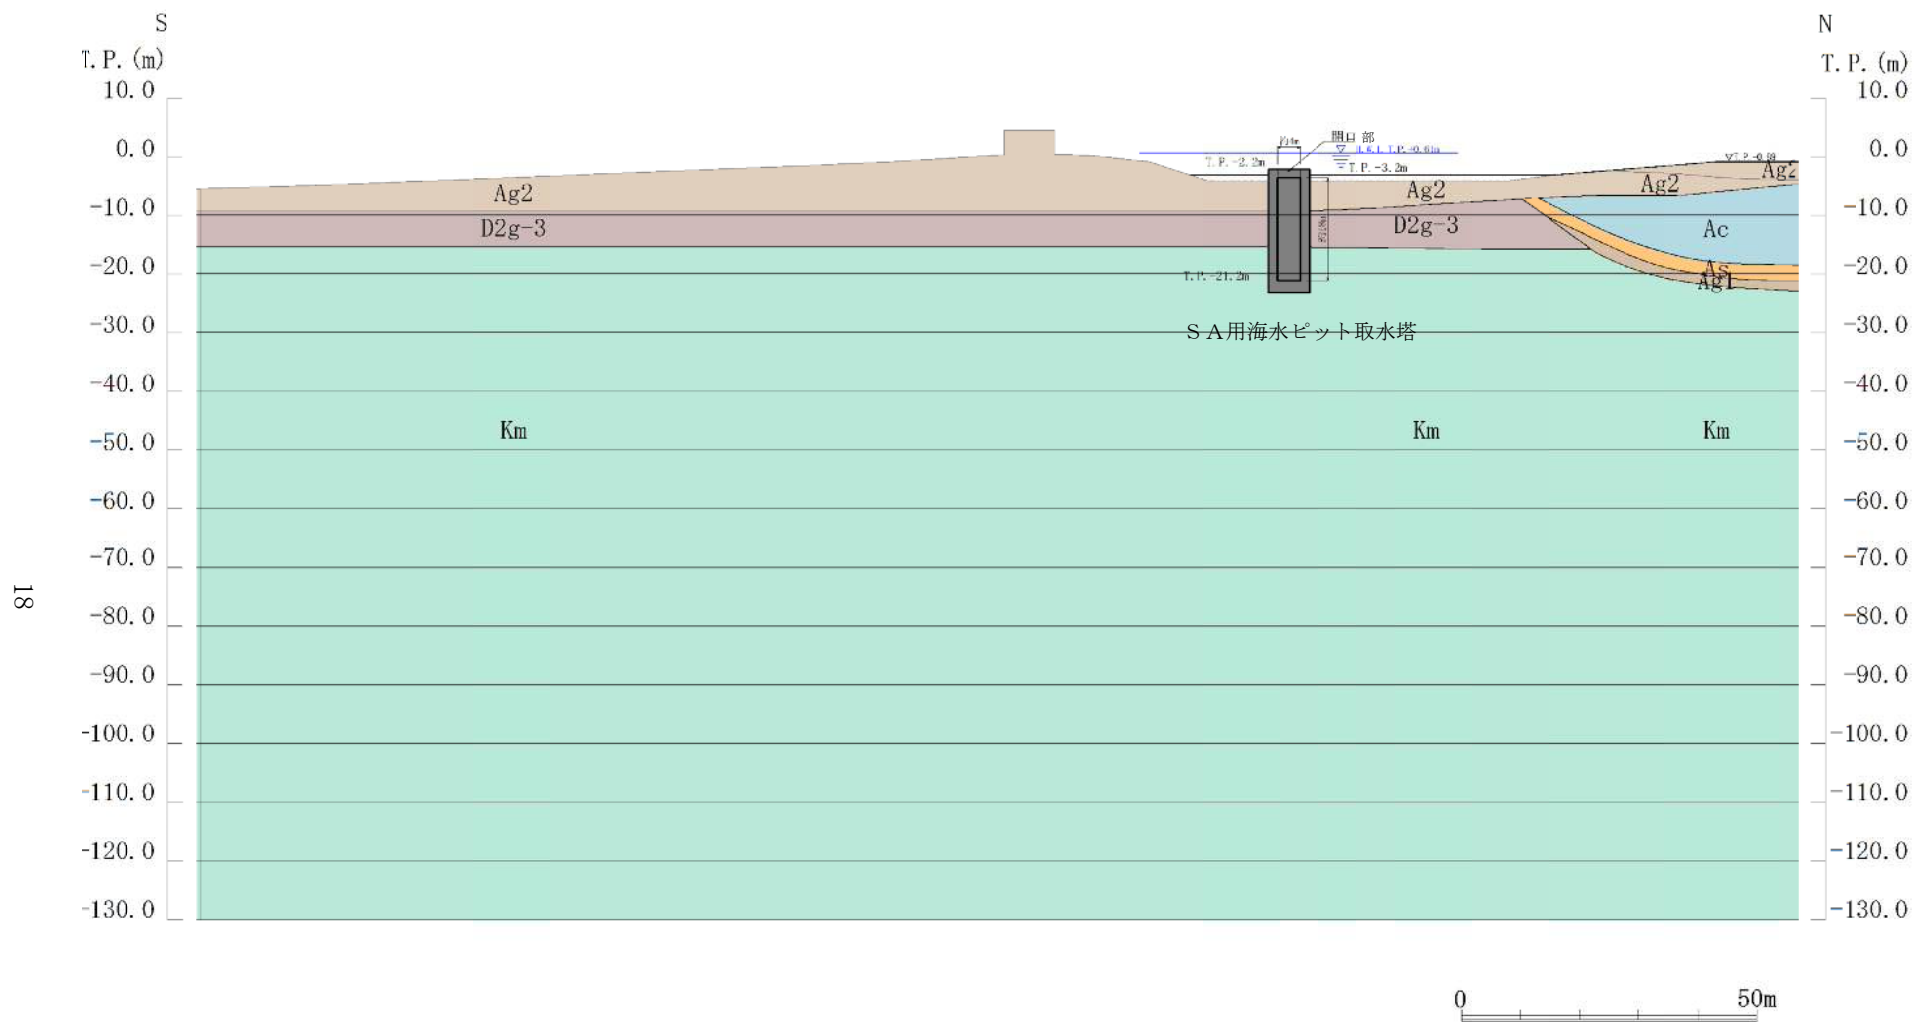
(2) SA用海水ピット取水塔 断面図 (②-②断面)
